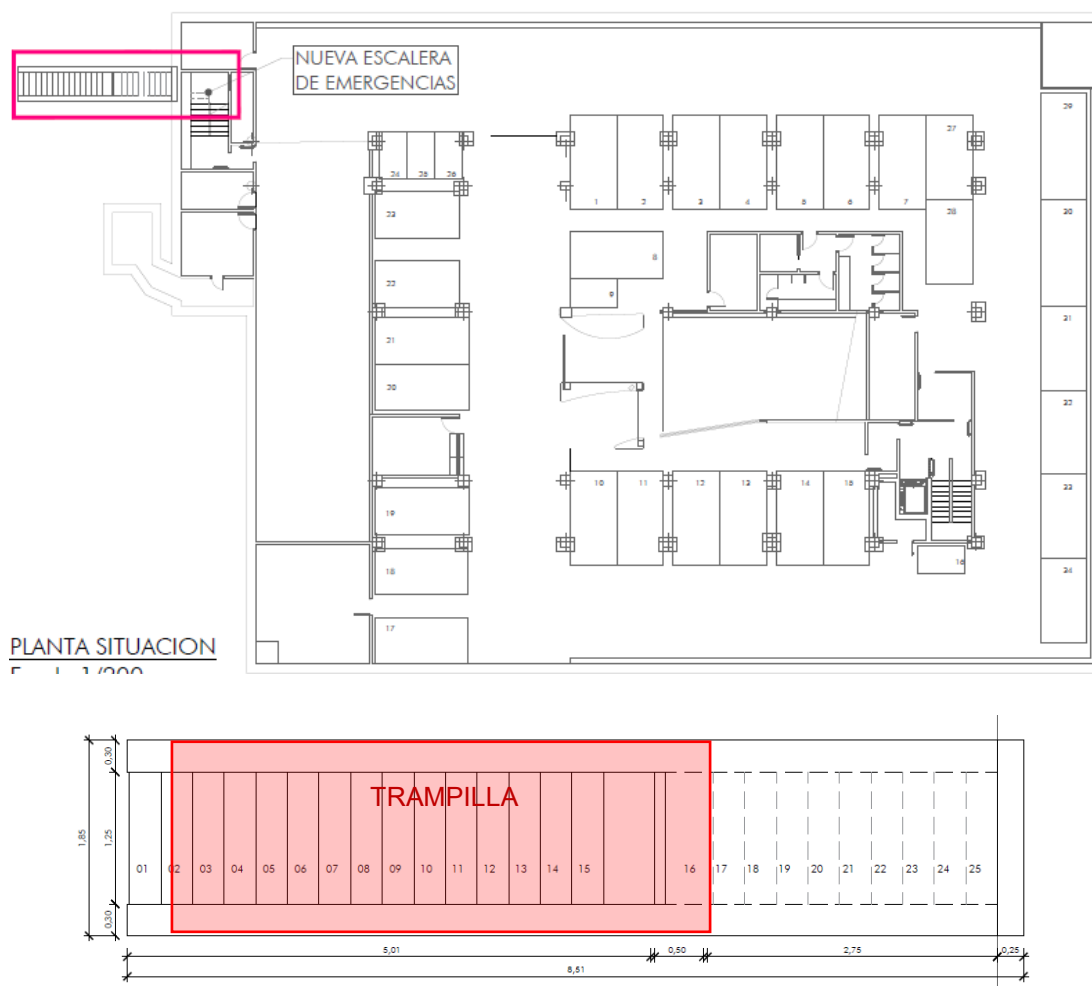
Salida de emergencias y trampilla– Vista en planta
